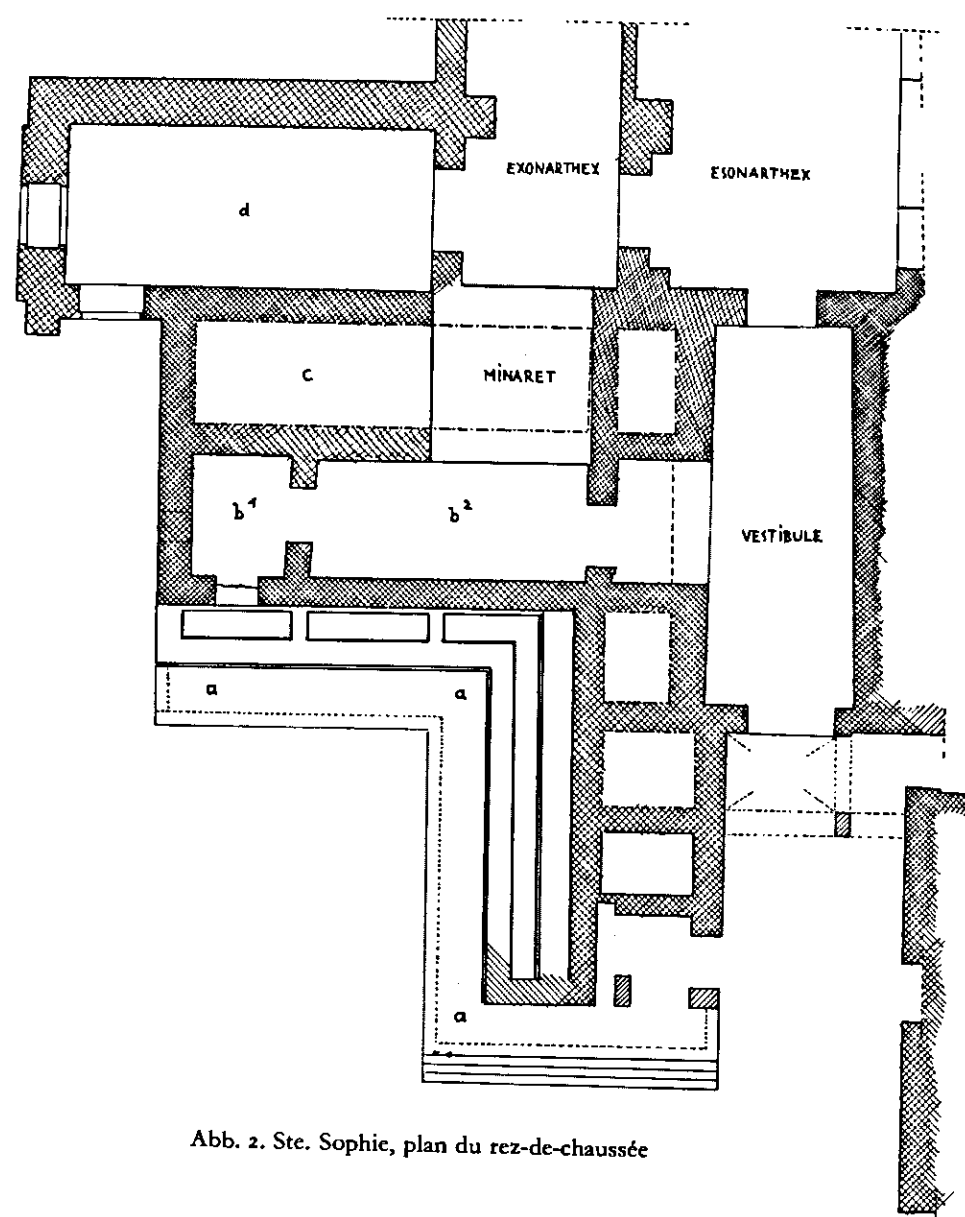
Ste. Sophie, plan du rez-de-chaussée
